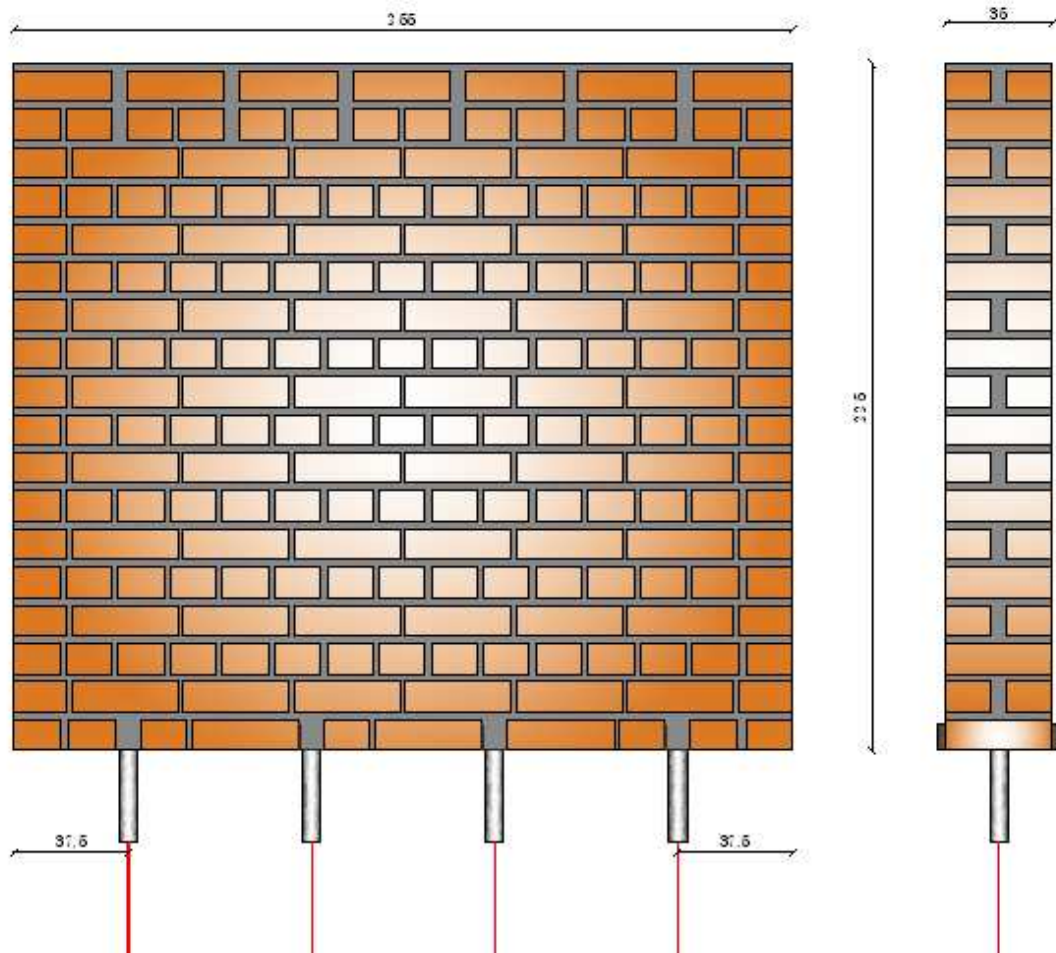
Dimensiones de apoyo antideslizante.
